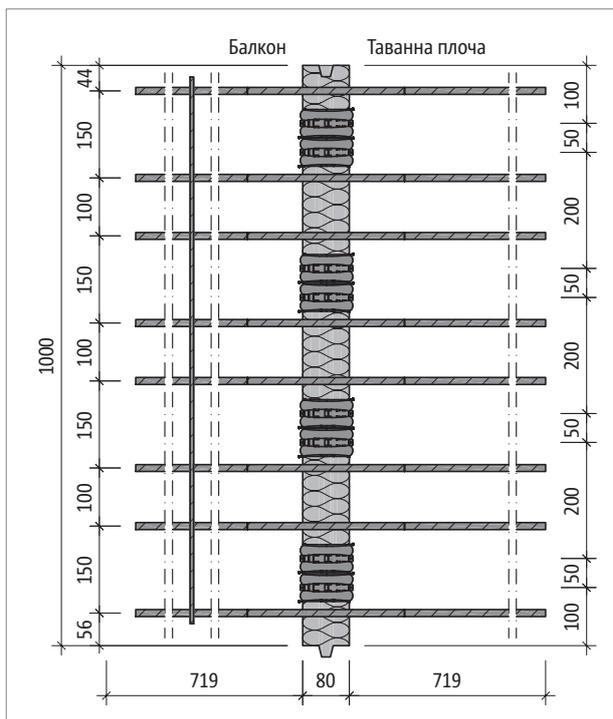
Schöck Isokorb® T мунове от QL-VV5 до QL-VV6: Сечение на продукта
